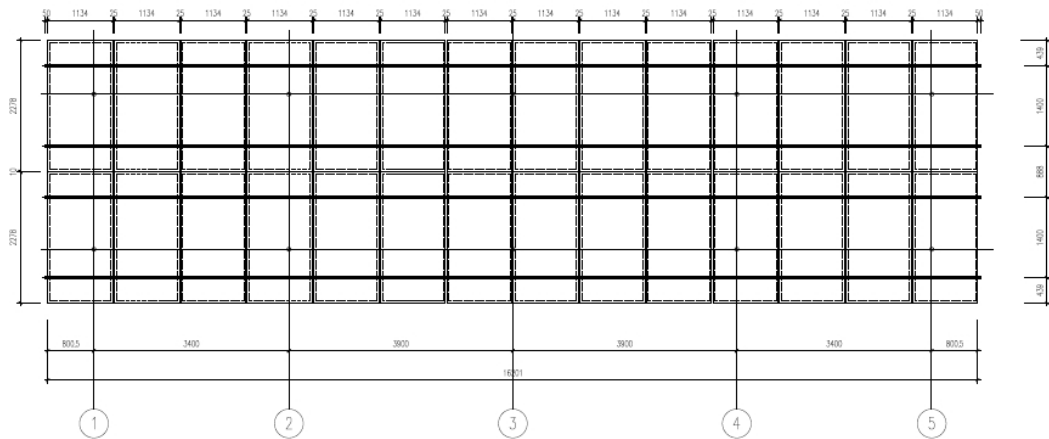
单立柱 2×13 支架组件平面布置图（柱距 4.0m）
